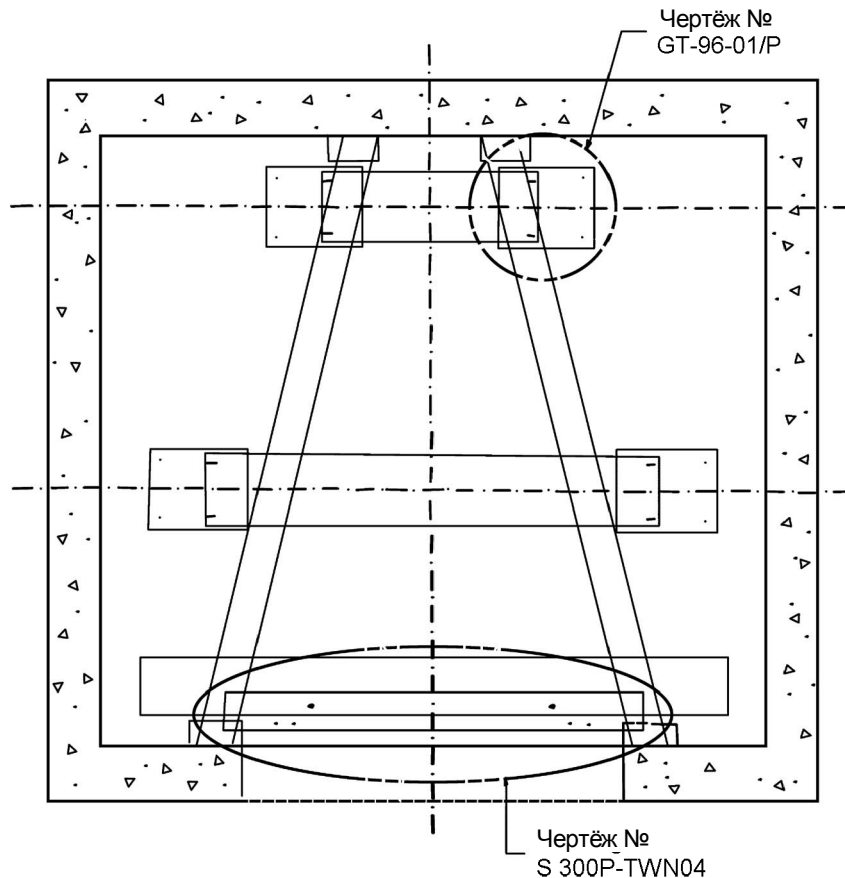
Схема шаблонов / чертёж № S300P-TWN01
